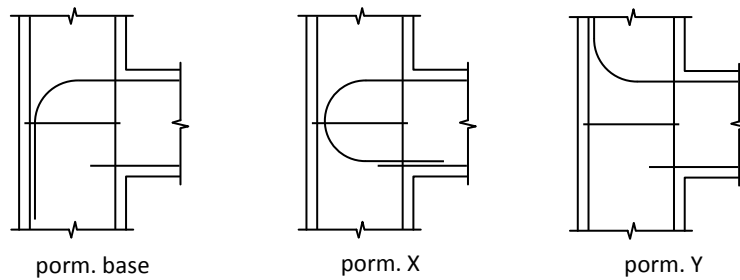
Pormenorização da armadura das ligações viga-pilar (Taylor [1974]).
